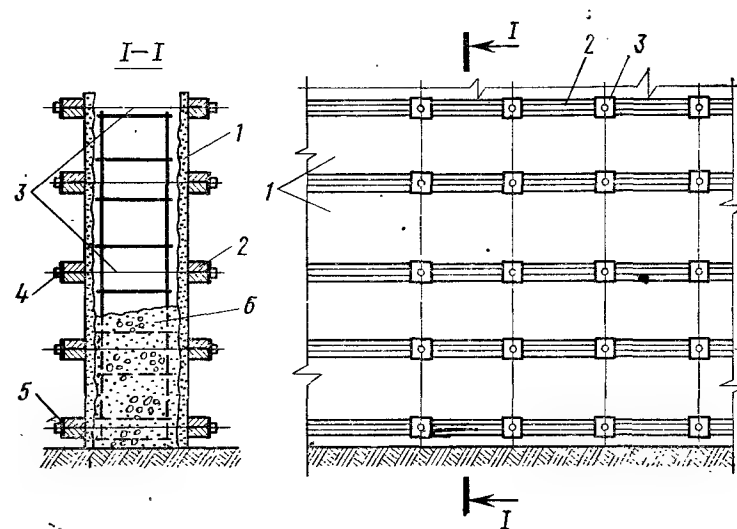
Крепление армоцементной опалубки облицовки с помощью инвентарных прогонов:
